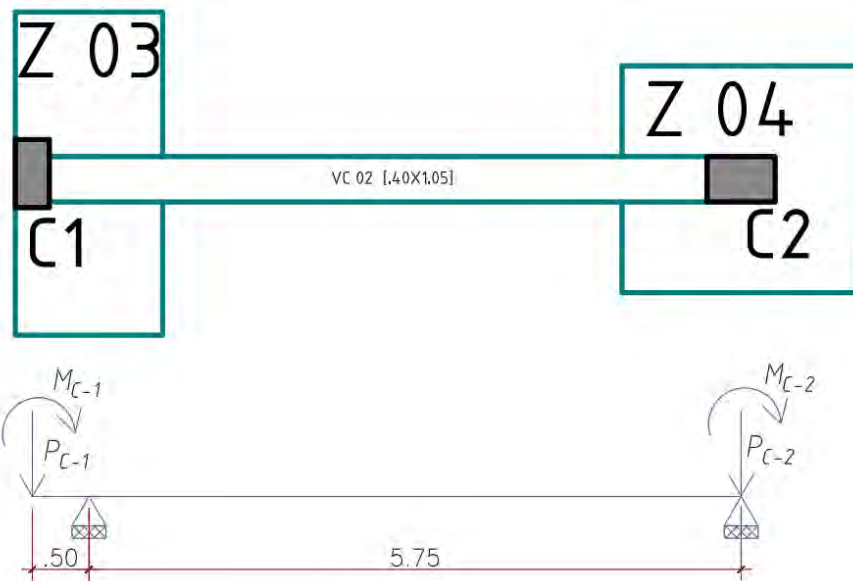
Modelo matemático de la viga de cimentación entre las columnas C1 y C2.
